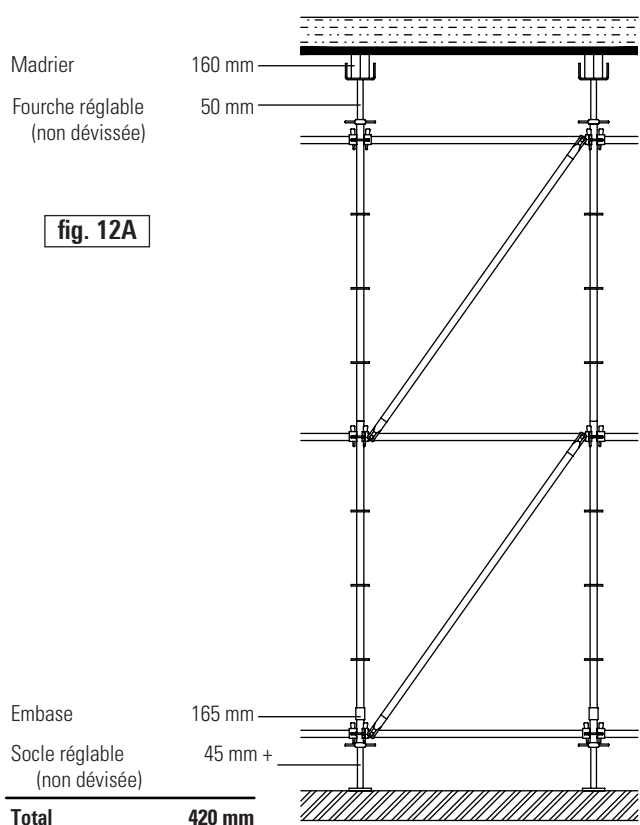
Étaieage de coffrages de sol avec panneaux bétonplex
